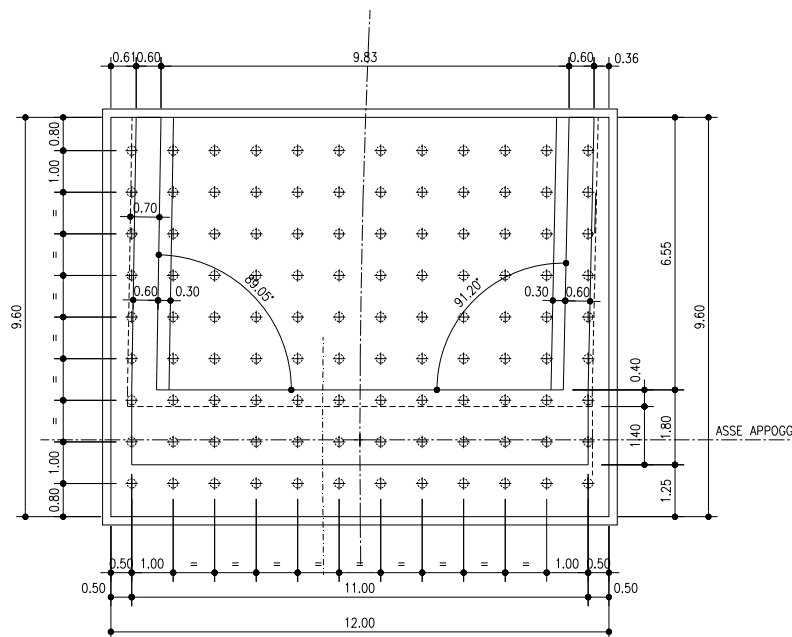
Pila 1 e 2 – Sezione Frontale Fondazioni
